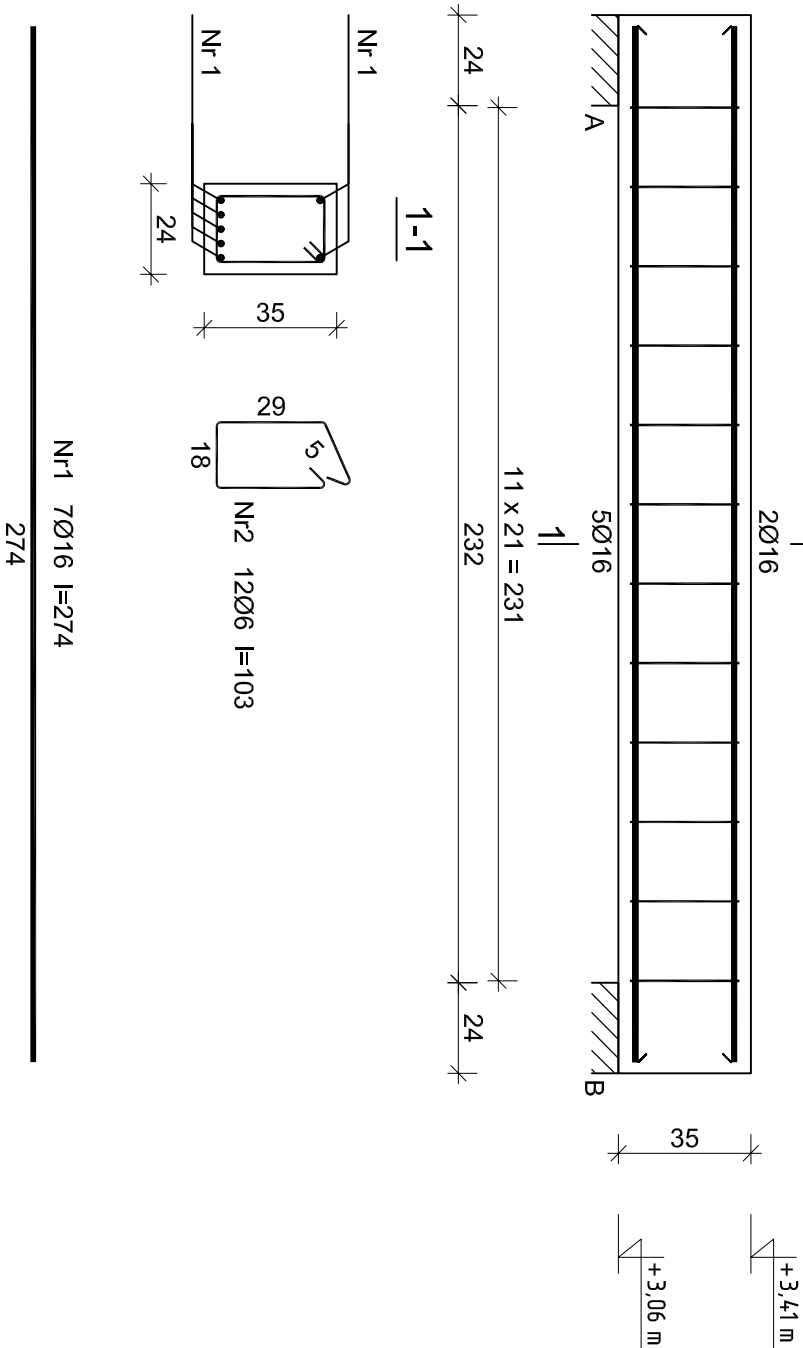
Poz. 2 – Nadproże żelbetowe
